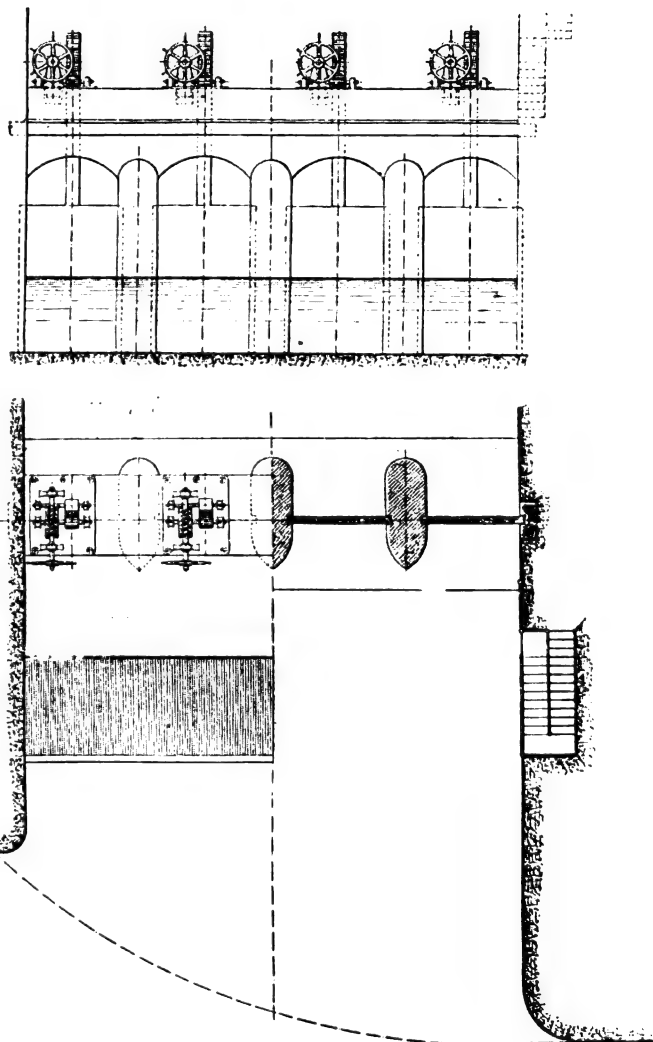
Entrée du canal de prise ; élévation transversale et plan.
